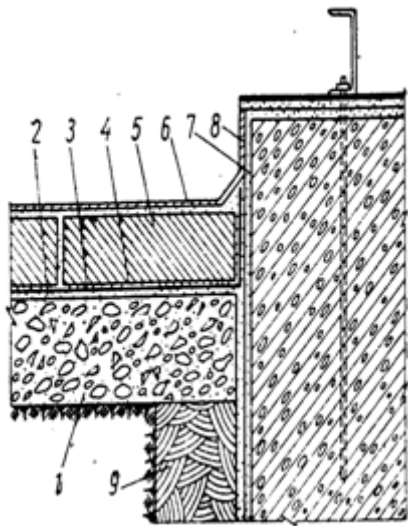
Деталь примыкания кислотостойкого пола к фундаменту оборудования:
